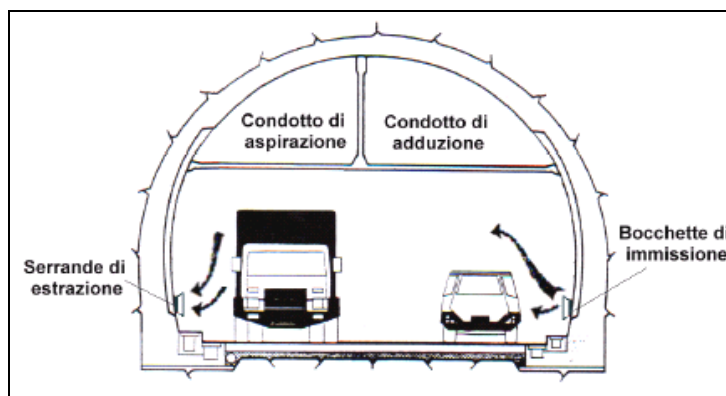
Sezione provvista di impianto di ventilazione trasversale con i condotti alloggiati superiormente. Fonte [12]
